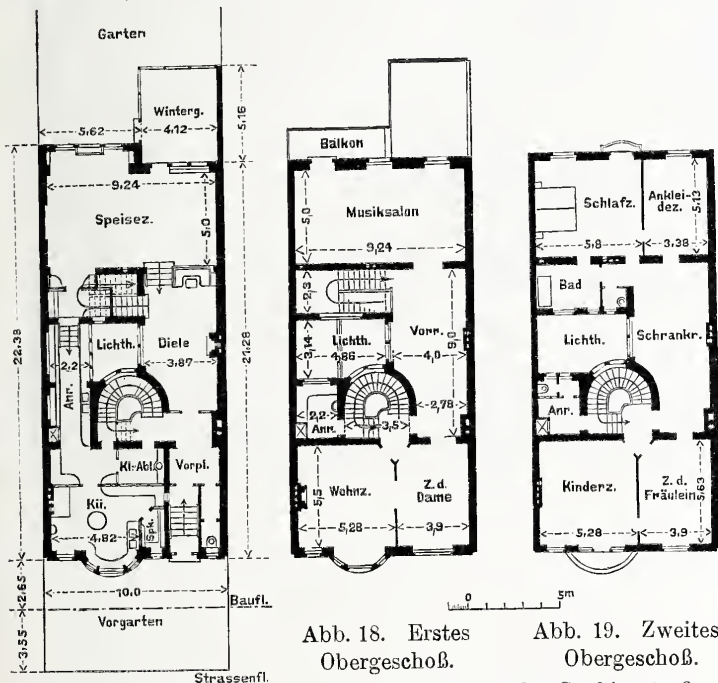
Erstes Obergeschoß. Abb. 19. Zweites Obergeschoß.
